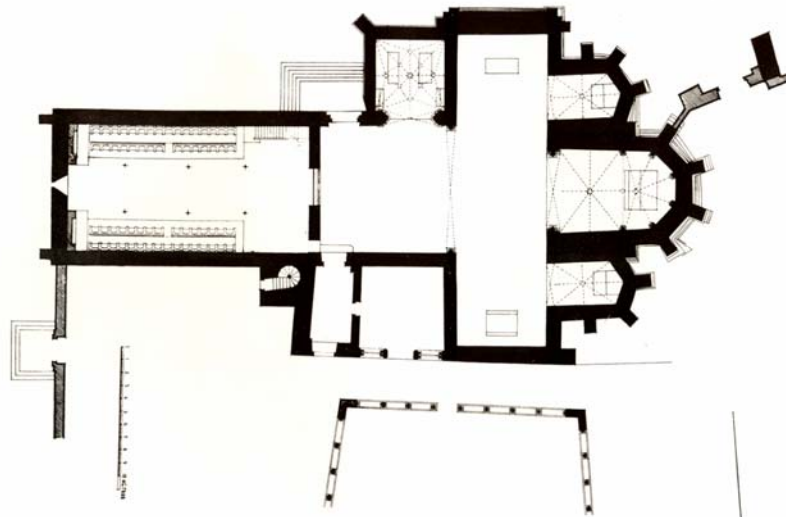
Santa Clara de Vila do Conde, planta (DGEMN).
